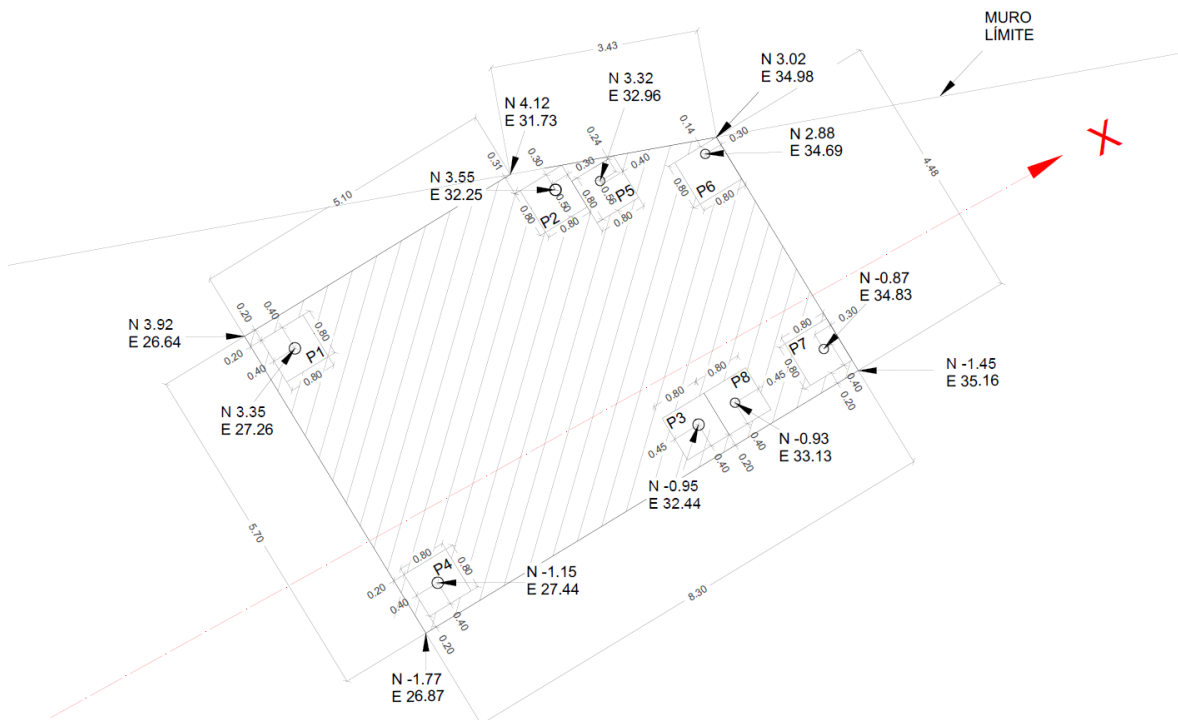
Replanteo de la cimentación de la torre de llegada. Fuente: Proyecto instalación de parque Multiaventura sobre forjado del centro comercial LAGOH en Sevilla
